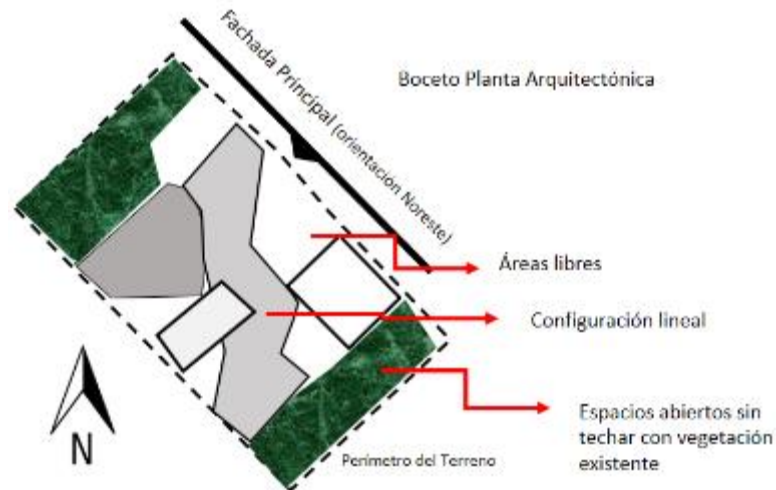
Boceto planta arquitectónica caso 3. Fuente: Elaboración propia
